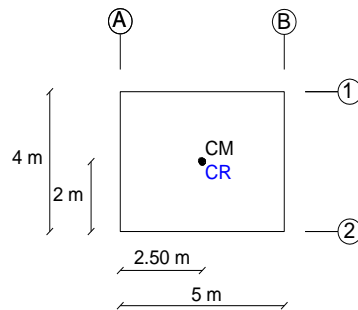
Centro de rigidez de la tercera planta de la superestructura
